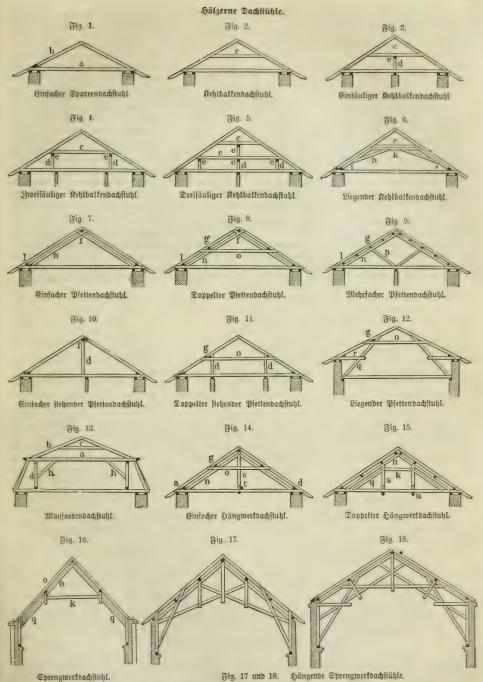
Solgerne Dachftuble mit geraden Sparren.
